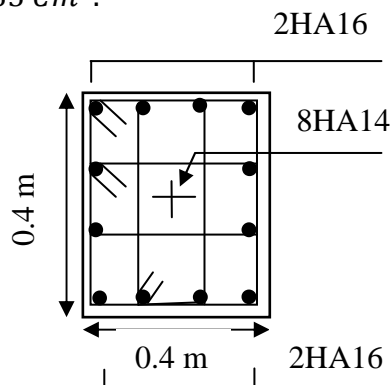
Schéma de ferraillage des poteaux rectangulaires de section (40 X 40) Cm².
